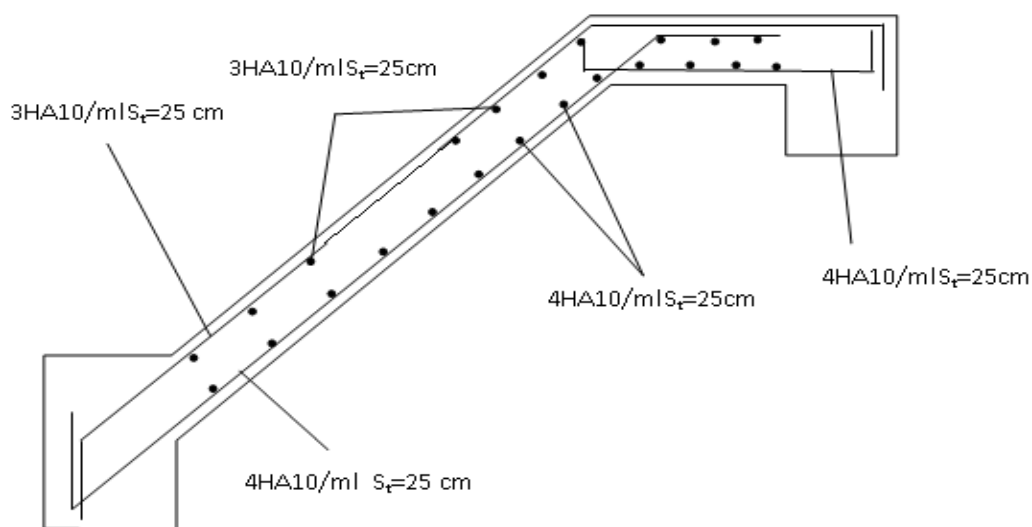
Schéma de ferrailage d'Escalier type 2
